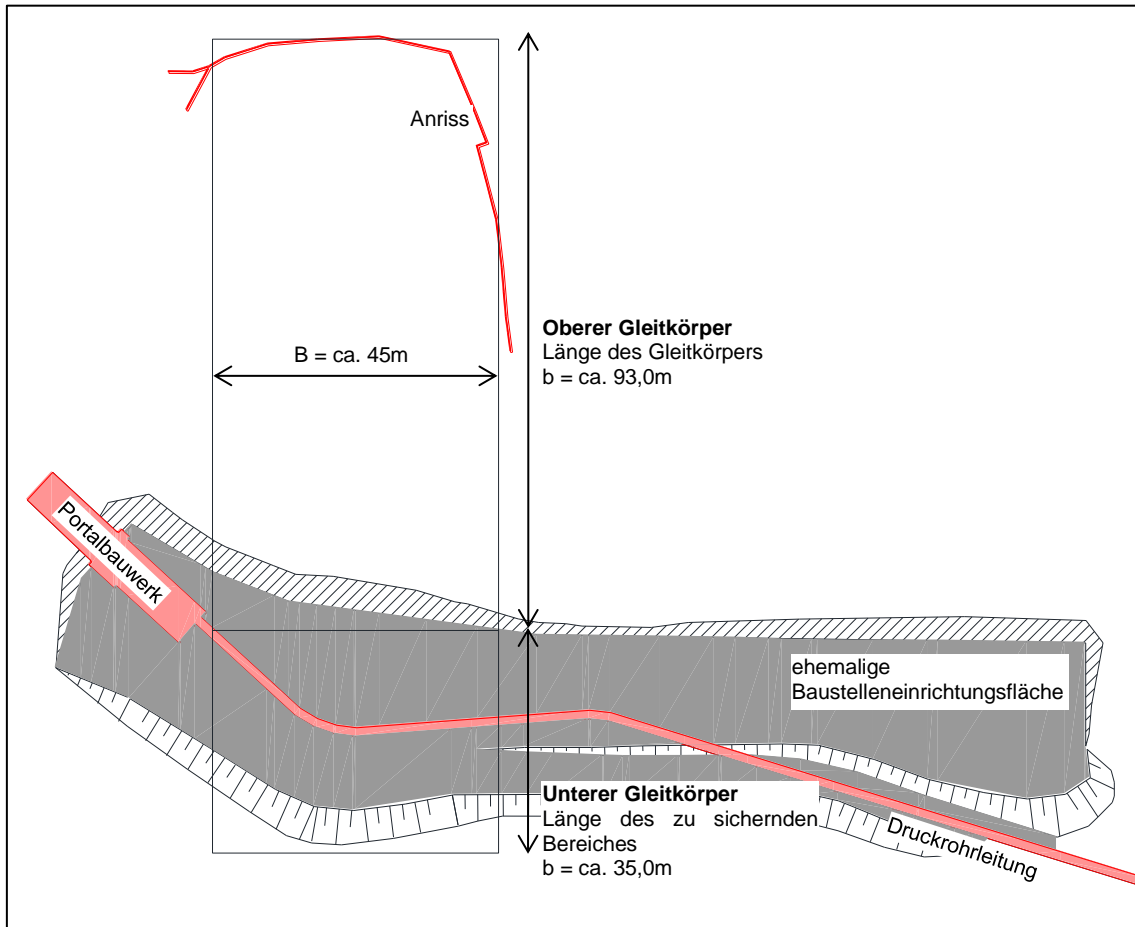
Lageplan mit Geometrie im Endzustand, gemäß [3]
